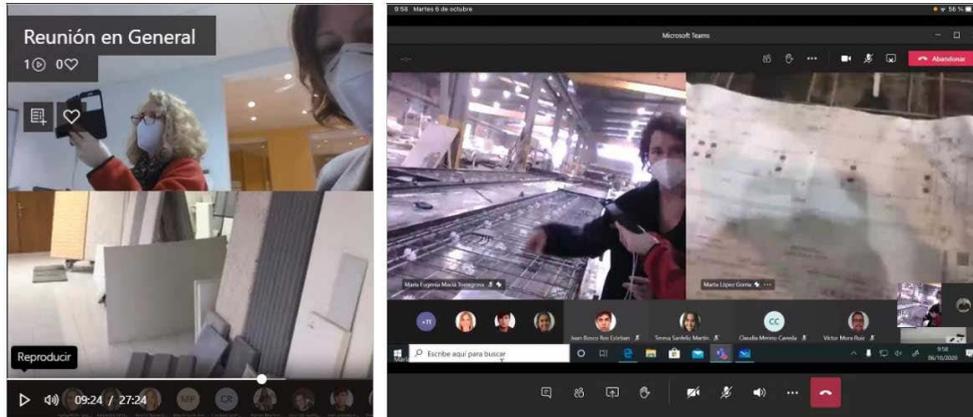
Imágenes del interior de las instalaciones de la empresa de paneles prefabricados de hormigón Prehorquisa
